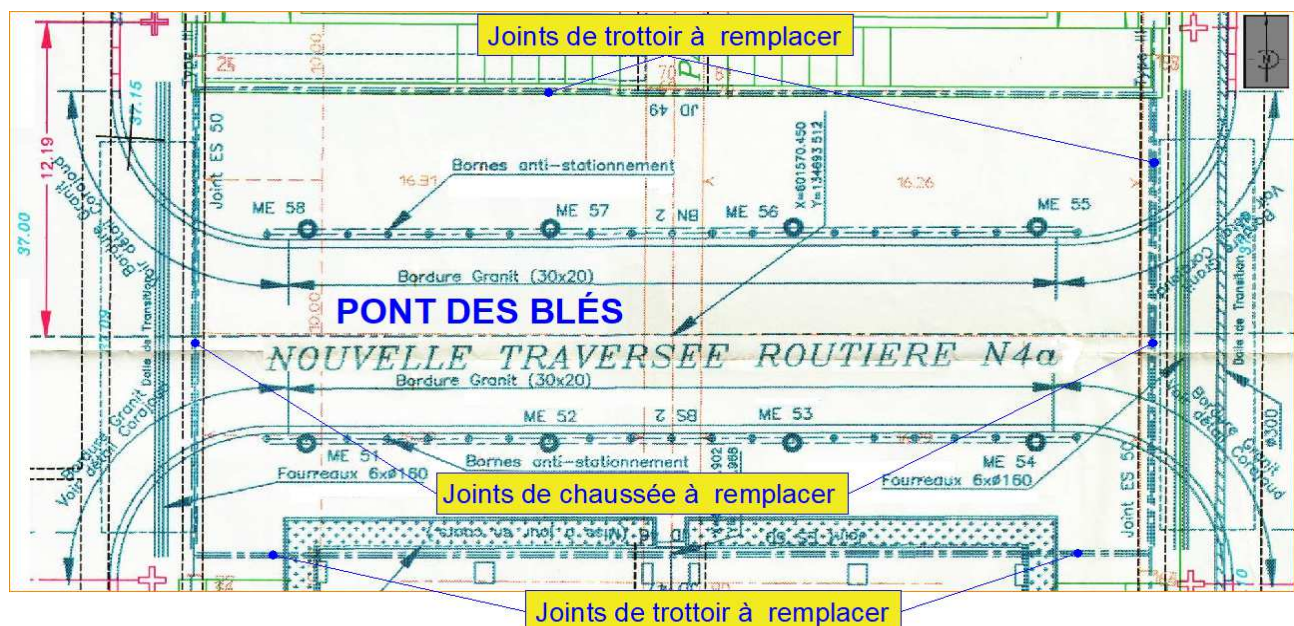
Extrait de la vue en plan des joints de chaussée du Pont des Blés
